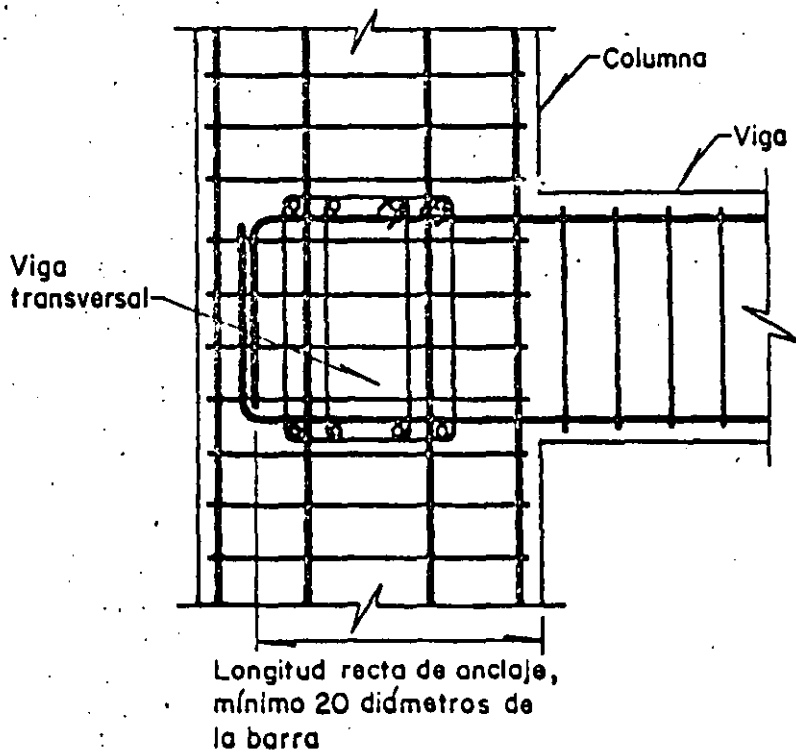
Ejemplo de unión viga-columna extrema según NTC del RDF87
